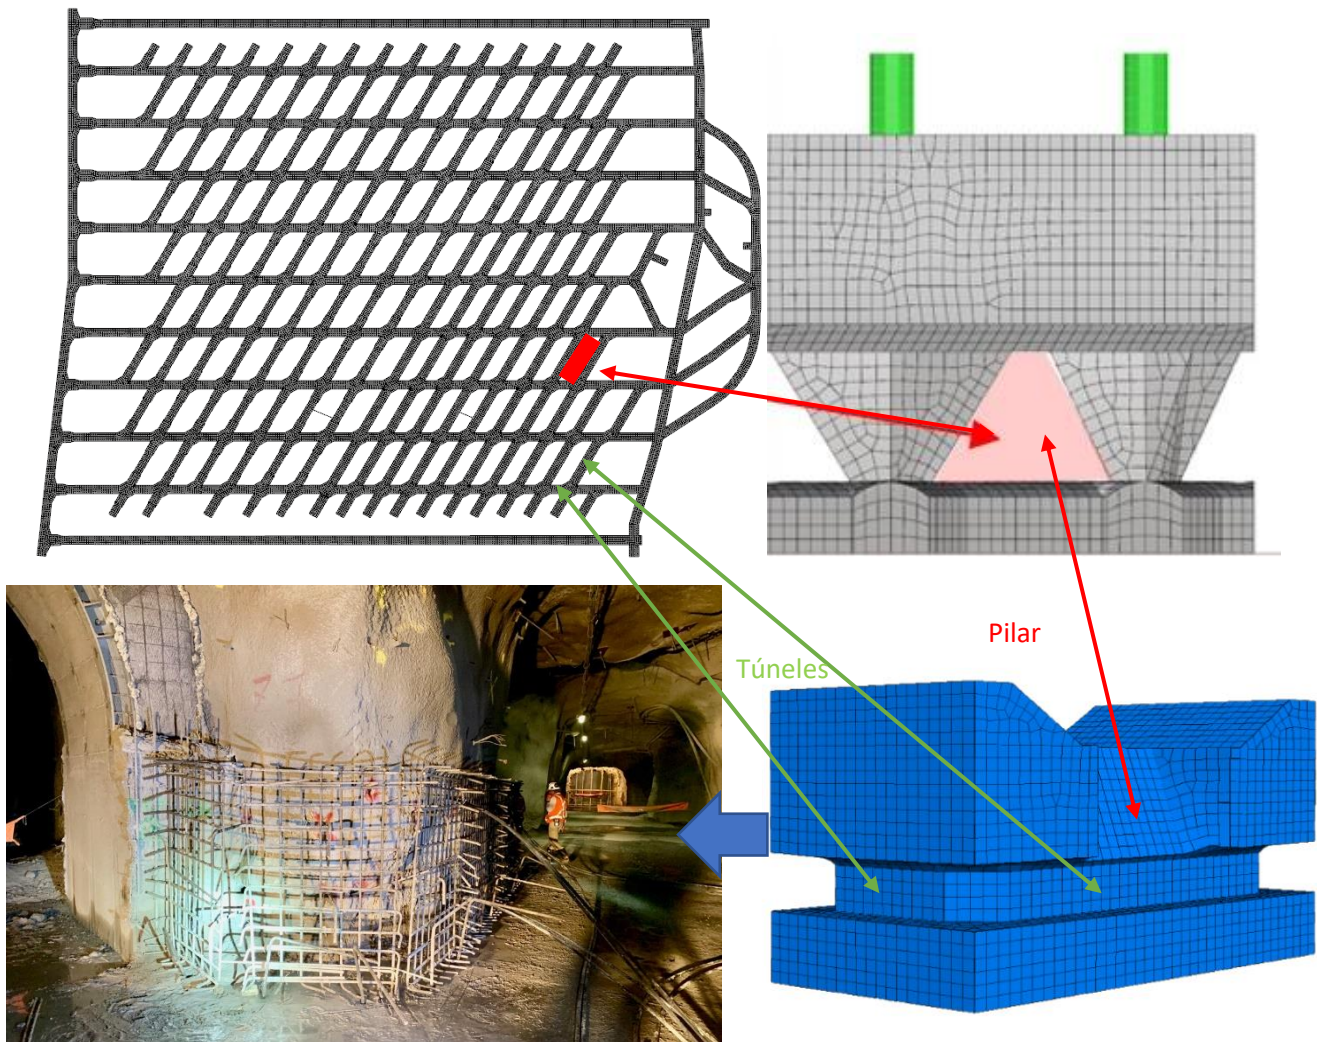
Sistema de extracción de panel caving visto en planta, malla de pilar tridimensional y pilar real (Montiel E., 2020).
